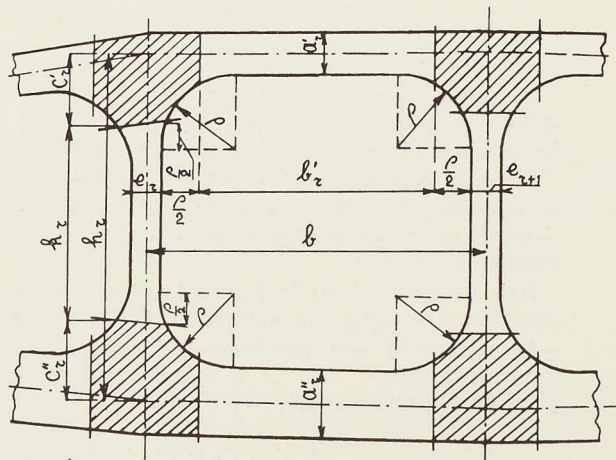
Cas d'une poutre à grands congés de raccordement.
